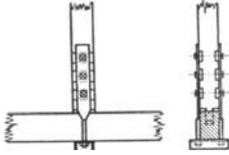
Anschluß der Hängesäule an den Streckbalken.
